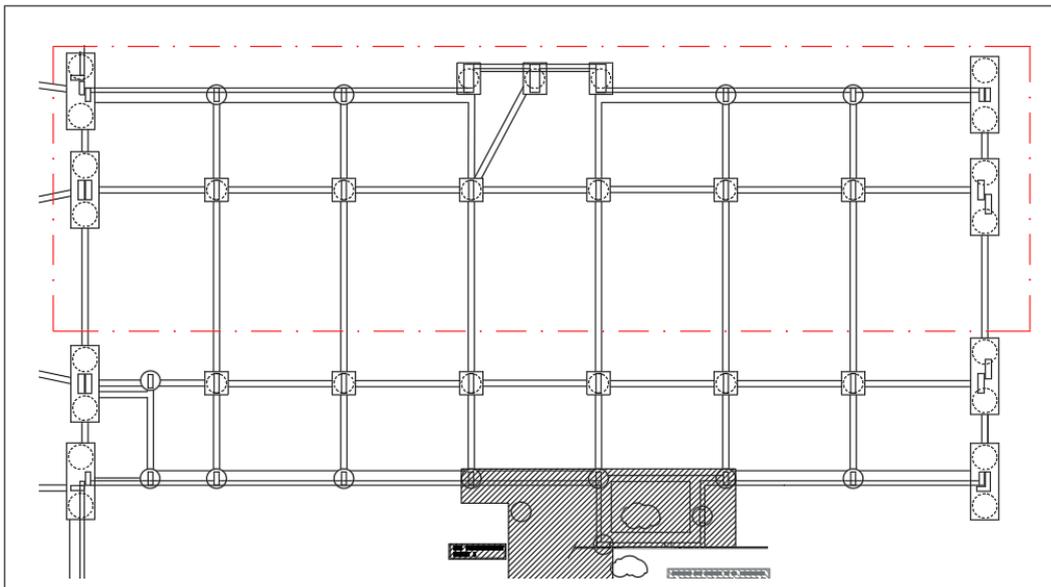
Excavación Sector C – Primer Etapa.
